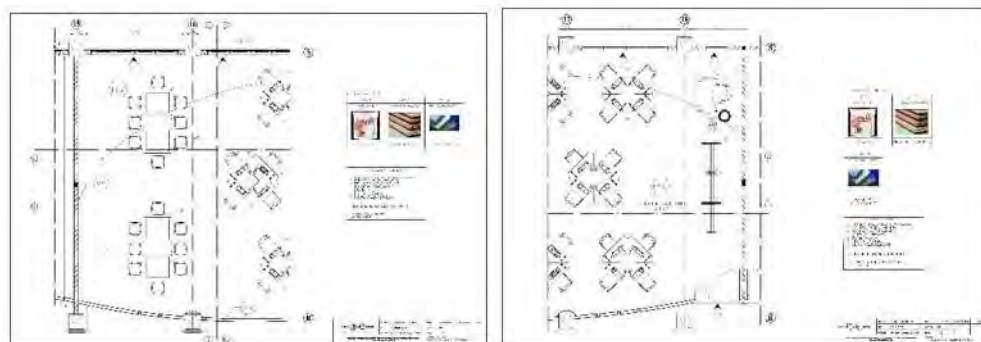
Pengembangan layout terpilih lantai 2
